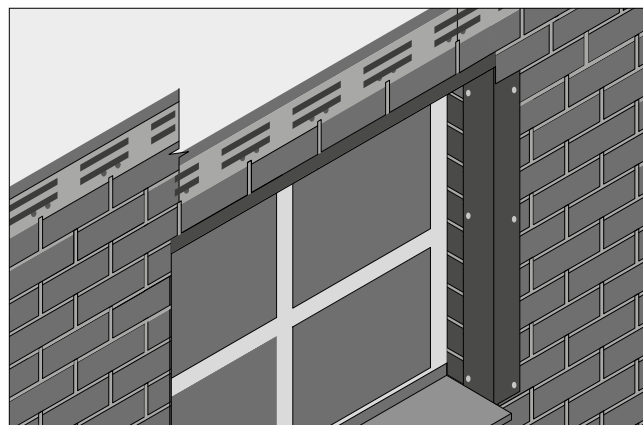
Монтаж фасадной плитки поверх оконного наличника сверху проема
